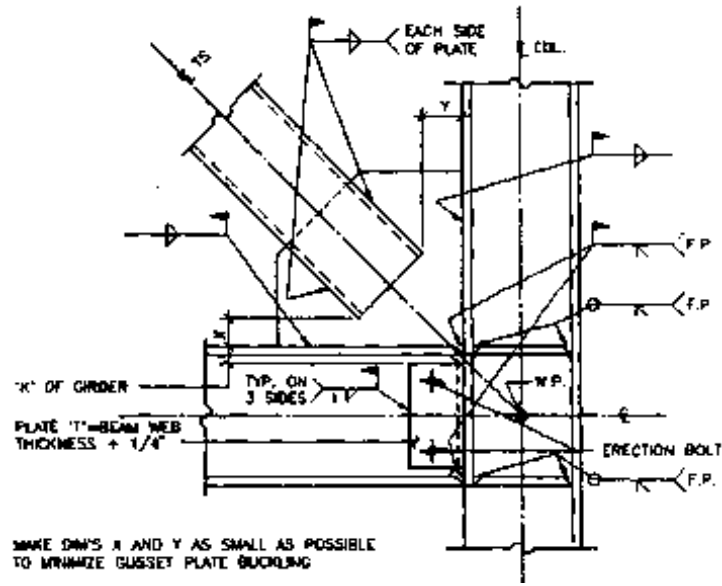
Conexión contraviento a columnas y viga con placa soldada (Becker, Ishler; 1996)
